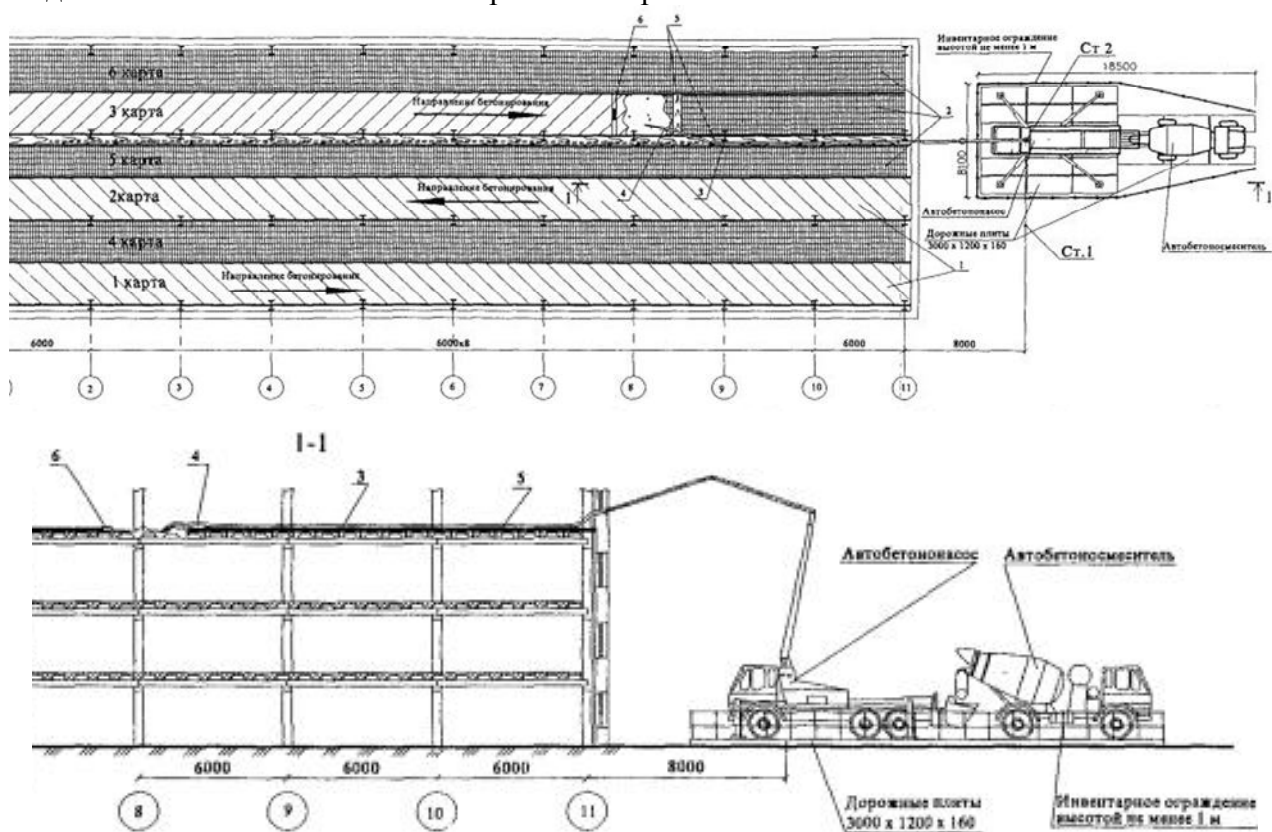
Производство работ по бетонированию плиты перекрытия:
